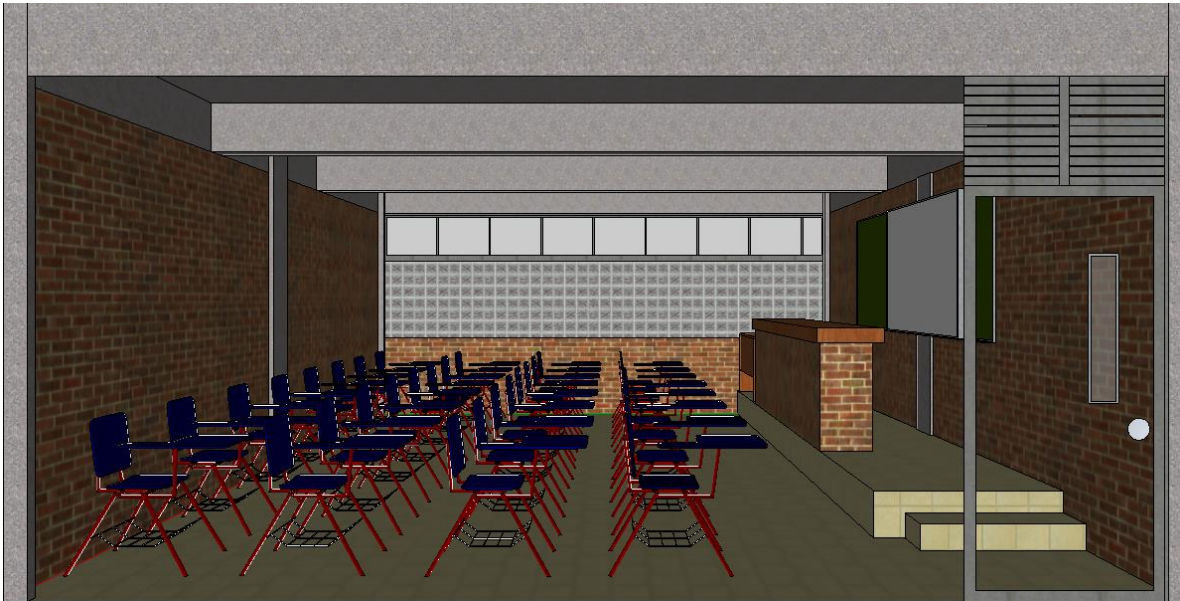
Salón A22 con detalles de superficie y vista al interior.
